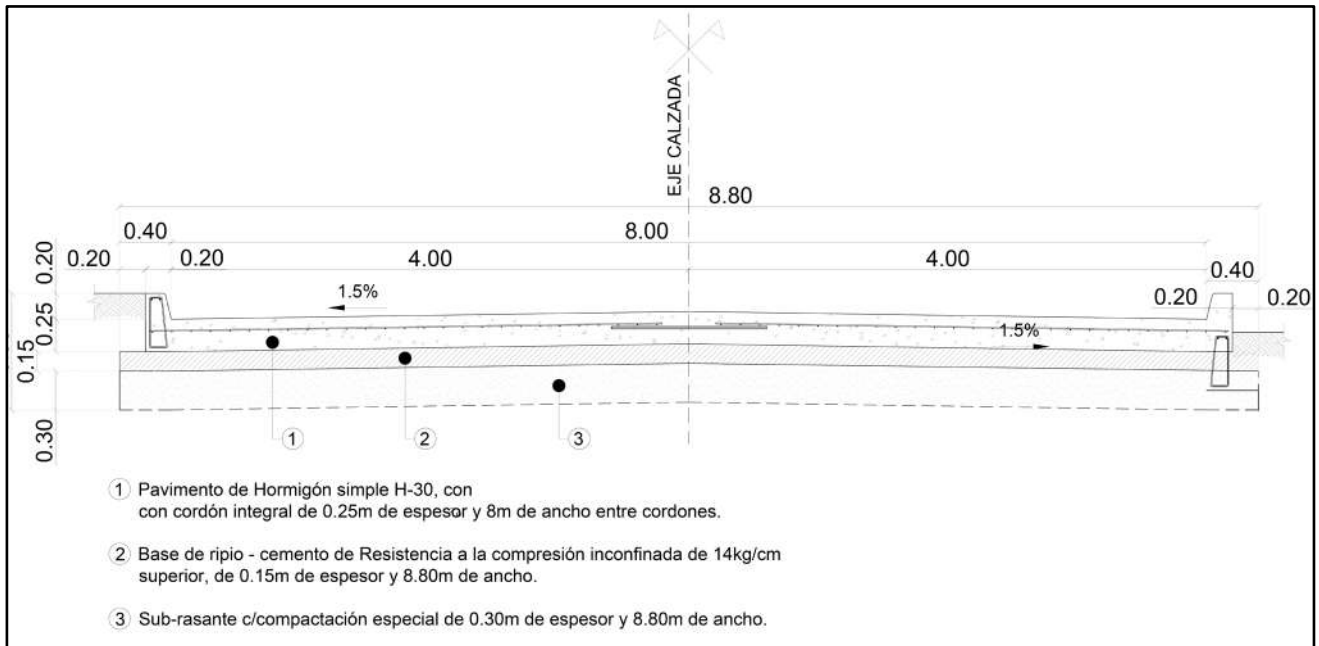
Sección Transversal Pavimento de Conexión con Sitio 5-6
